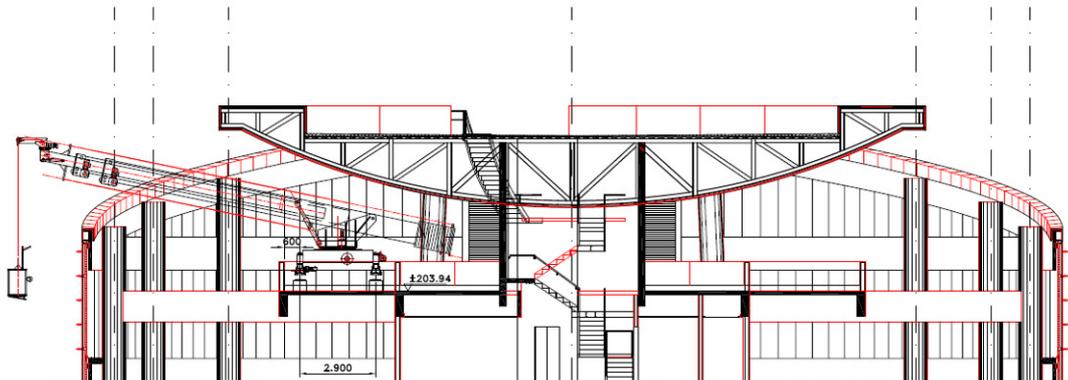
Projeto do sistema de limpeza das fachadas – corte
